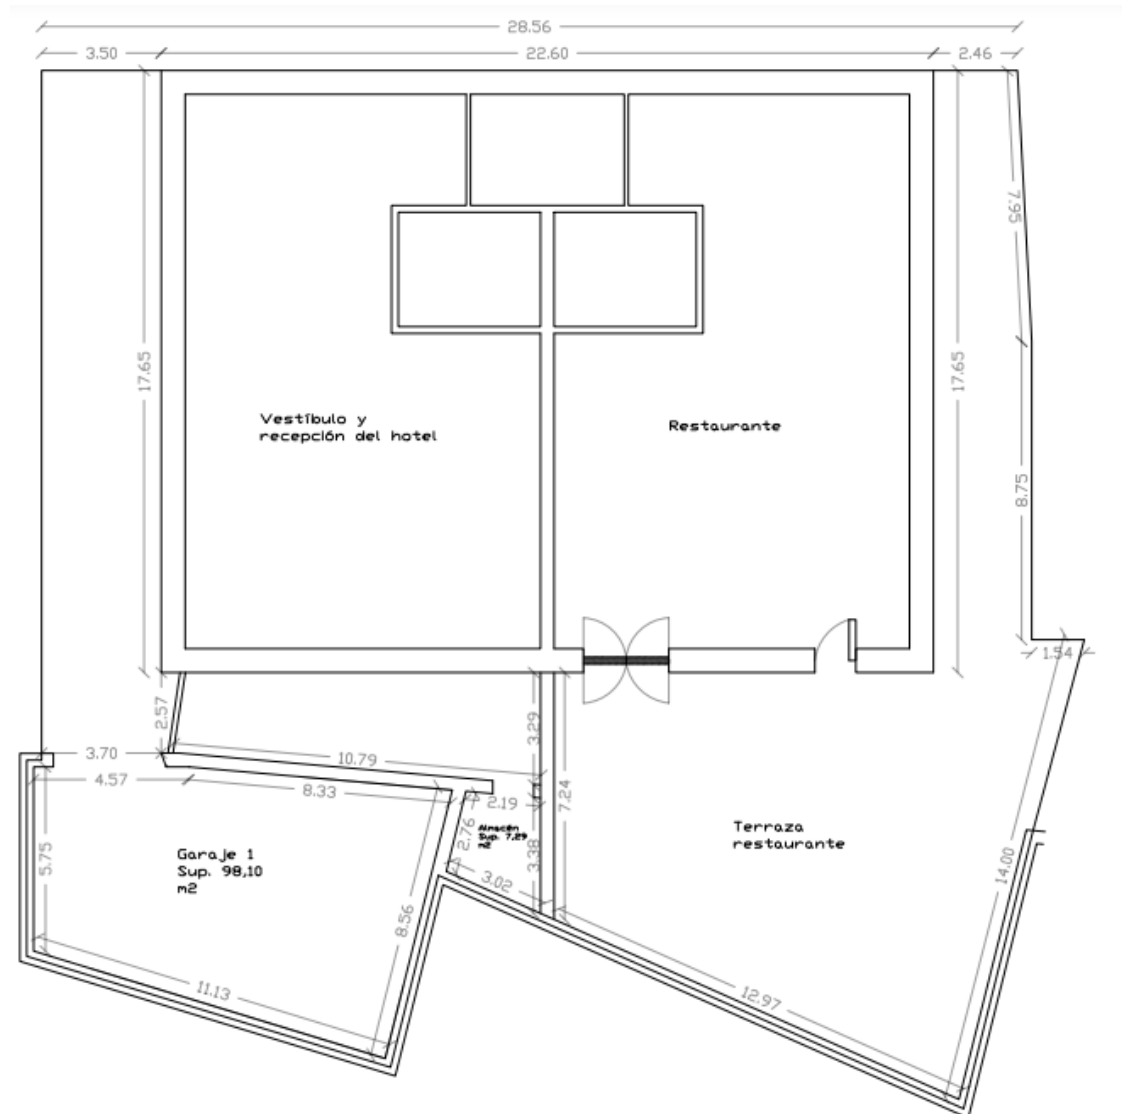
Extracto del plano del solar redistribuido. Fuente: Elaboración propia
